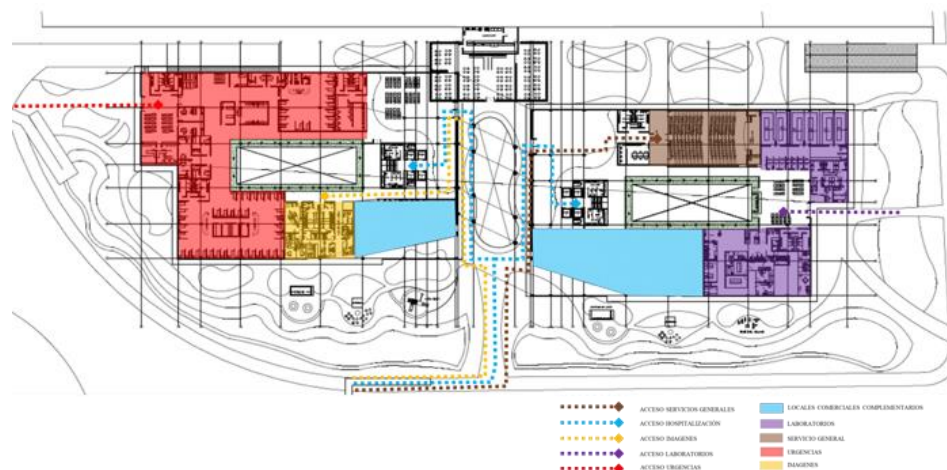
Planta primer piso con configuración de recorridos – Fuente: Elaboración propia
